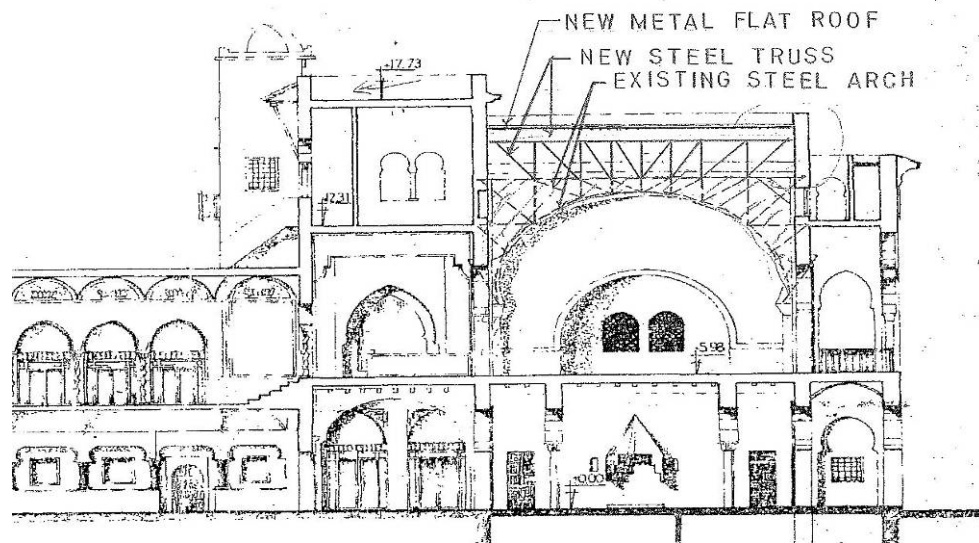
Renforcement de la toiture avec treillis d'acier supplémentaires aux arcs d'acier existants
